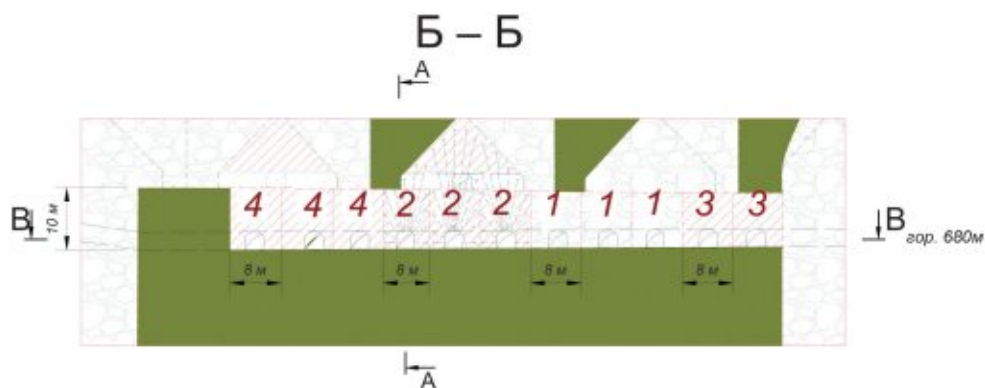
Системой разработки подэтажного обрушения с торцовым выпуском руды. Продольный разрез по Б – Б
